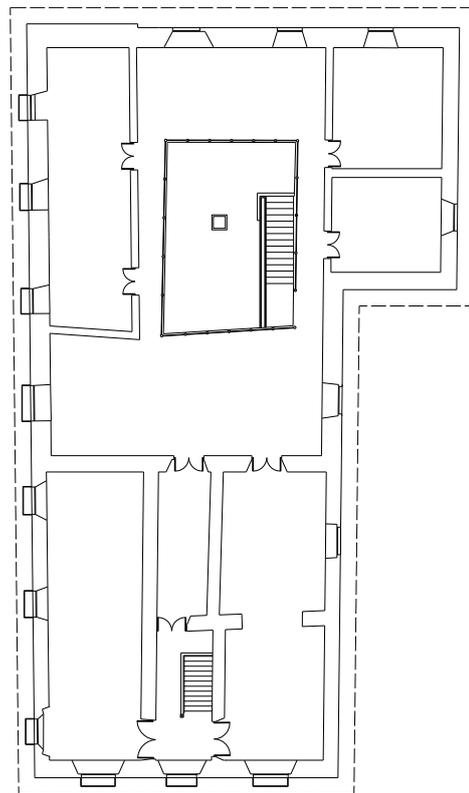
Planta Baixa Pavimento Superior antes da intervenção no ano de 2006
